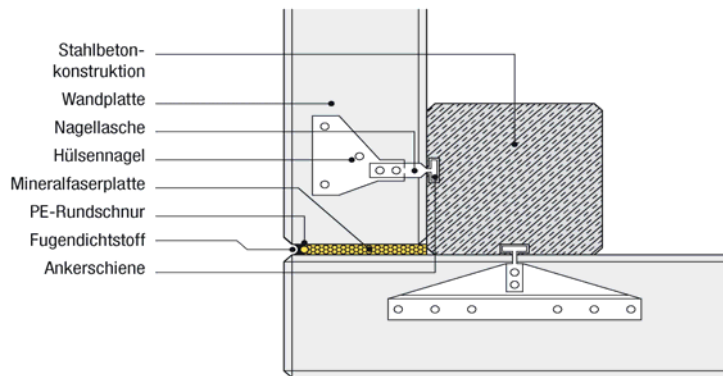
Befestigung von Porenbeton-Wandplatten mit Nagellaschen an Stahlbetonstützen
